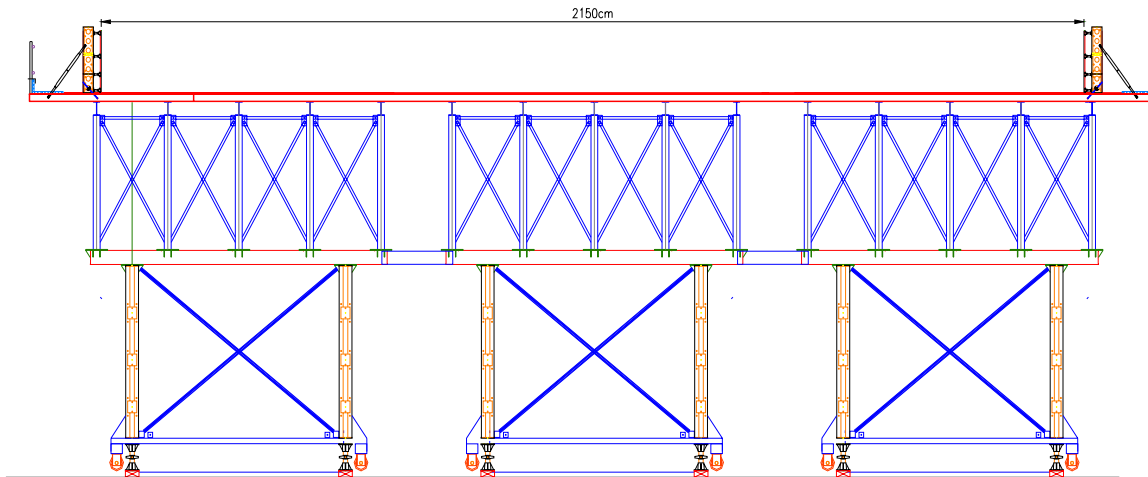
ELEVACIÓN DE CIMBRA PARA COLADO DE ETAPA No. 3.
